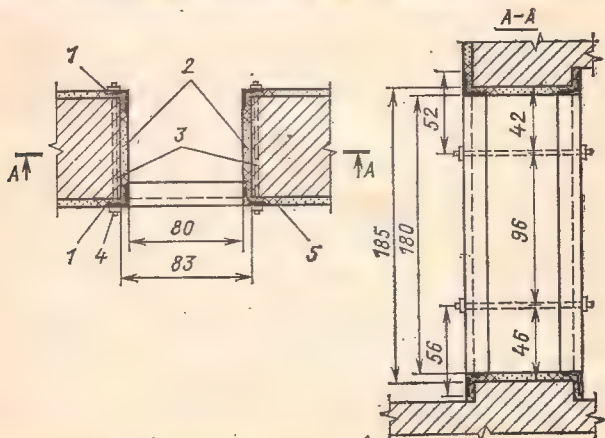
Крепление дверных коробок защитно-герметической и герметической дверей при устройстве дополнительного проема в стене убежища:
